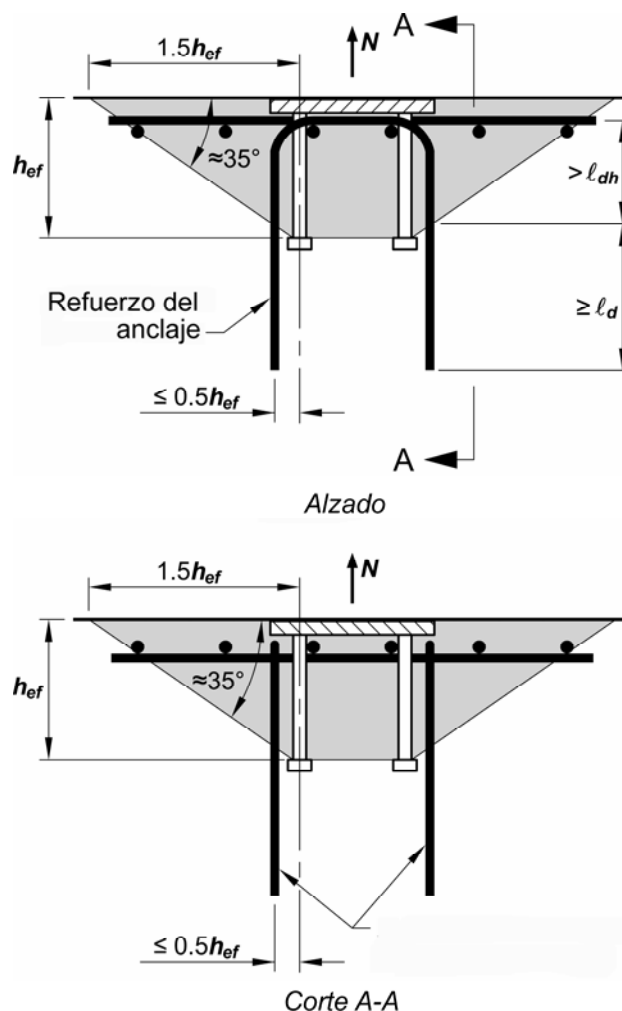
Refuerzo de anclaje para tracción
